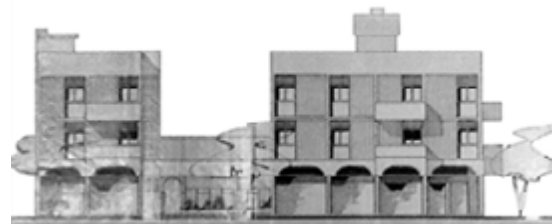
Vista del conjunto desde calle 48. Fuente: Plano original Arq. Nogueira.
